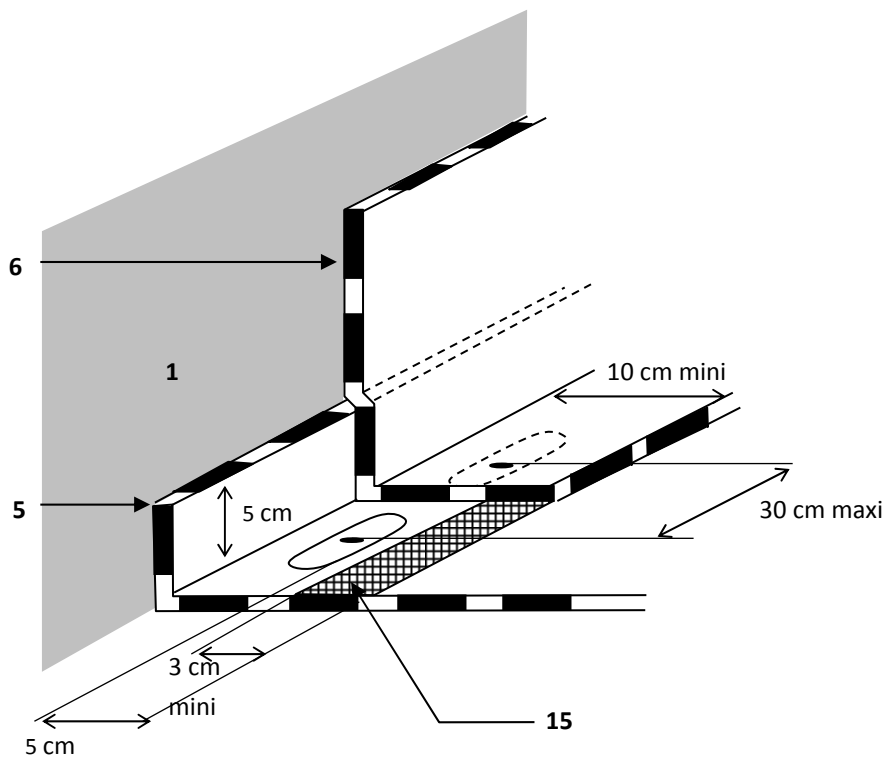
Relevés : recouvrements et soudures - dimensions à respecter
